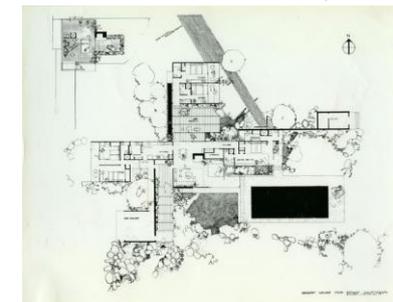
Kaufmann House, desierto de Palm Springs, 1946. Planta Baja.
